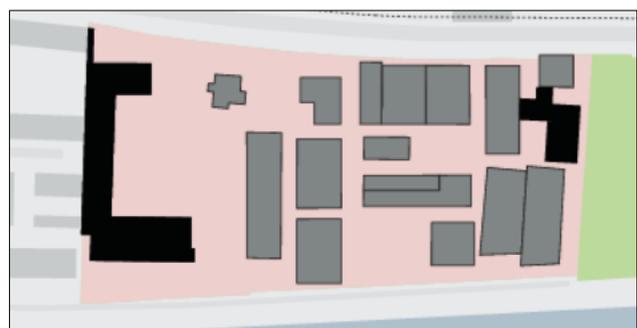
Gebäudebestand Südareal 1937. Schwarz: Bauten von O. R. Salvisberg, Bau 21 im Westen und Bau 27 im Osten. Quelle: Roche (Plan nicht genordet, kein Massstab)
